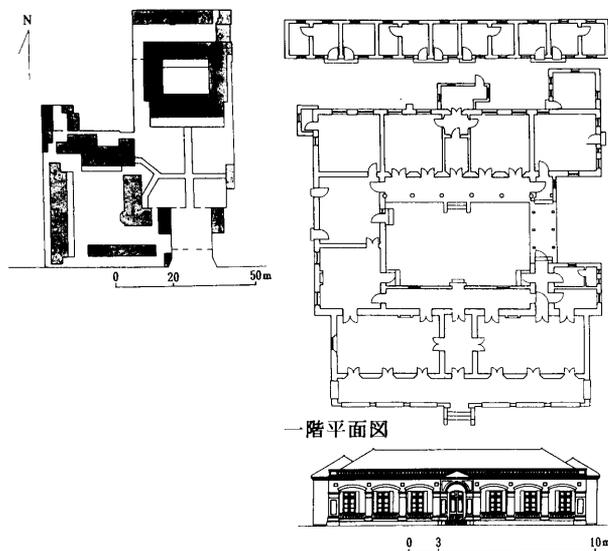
日本公使館の配置図と平面図（平面図及び立面図の出典；王世仁他主編『中国近代建築総覧・北京編』中国建築工業出版社，1993から作図）
